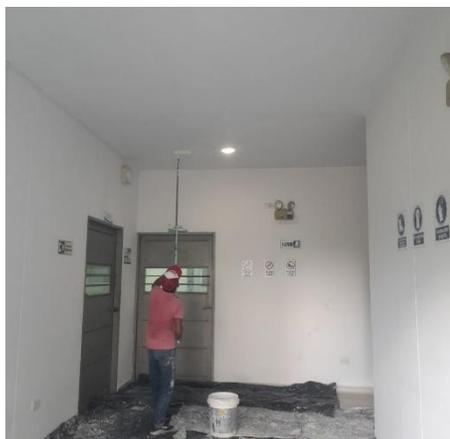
Impermeabilización de vigas canales en planta piloto y sellado de aberturas en tejado.
